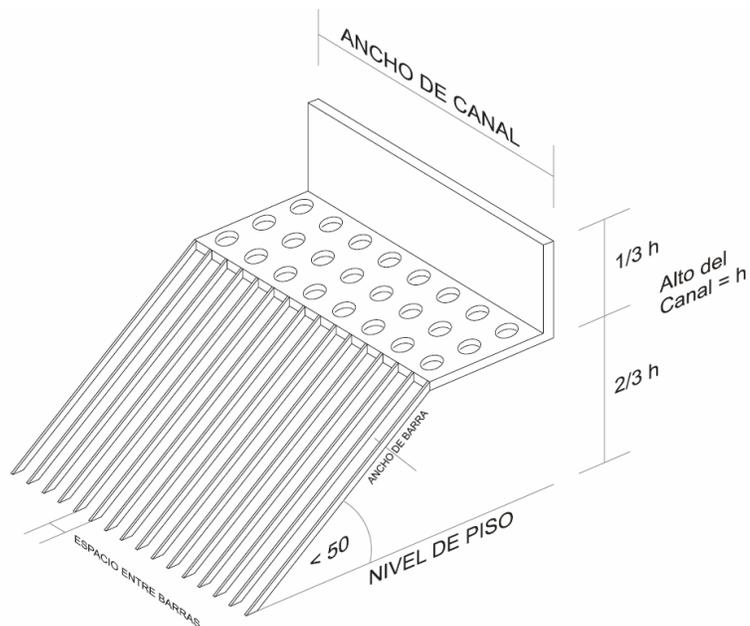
1 Detalle de las rejillas utilizadas en el canal de pretratamiento
